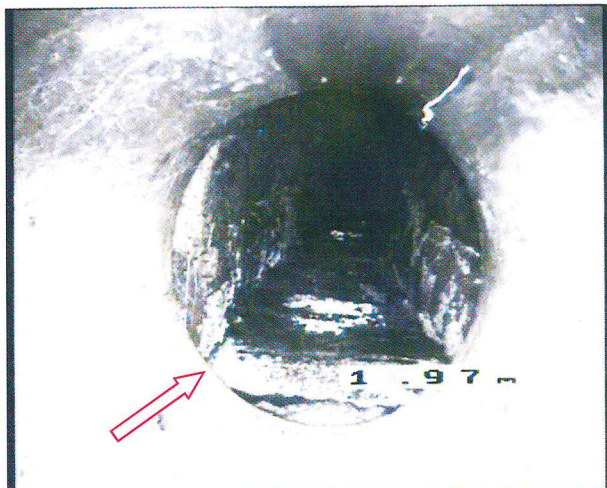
2,1m - geometrická změna profilu potrubí, obdélník
